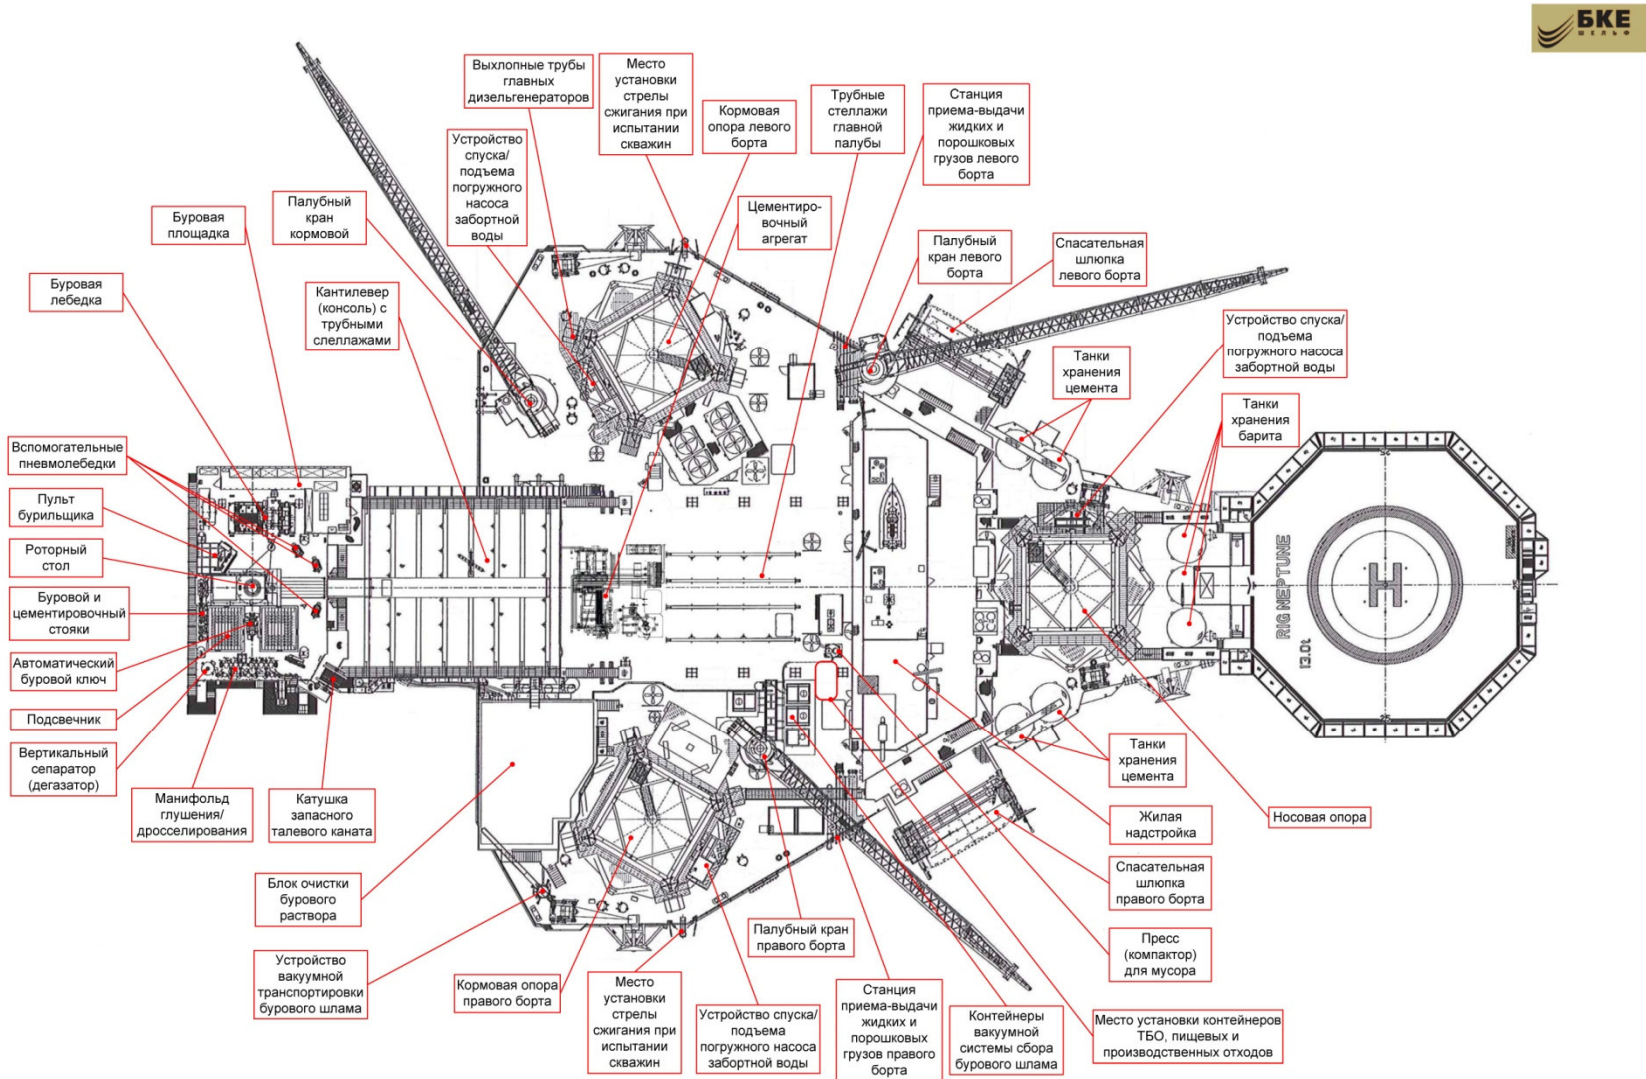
Схема общего расположения оборудования. Вид сверху
